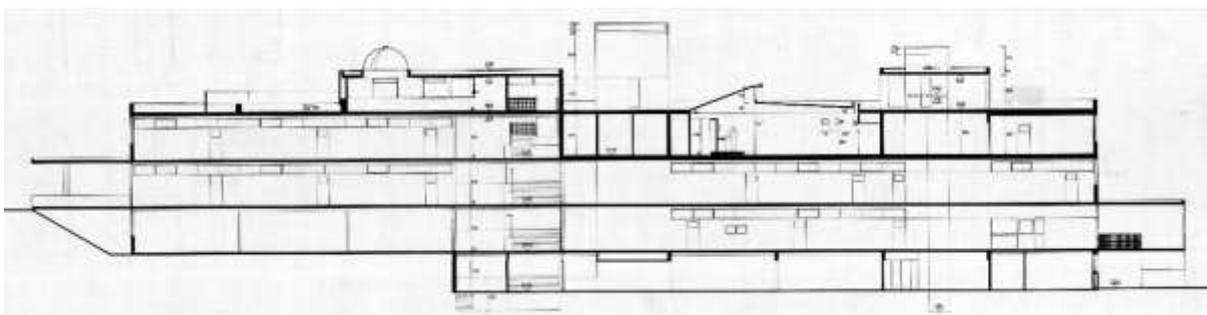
/ Corte EE detalle lámina PG08, 1961, DDI-Nº16.915
